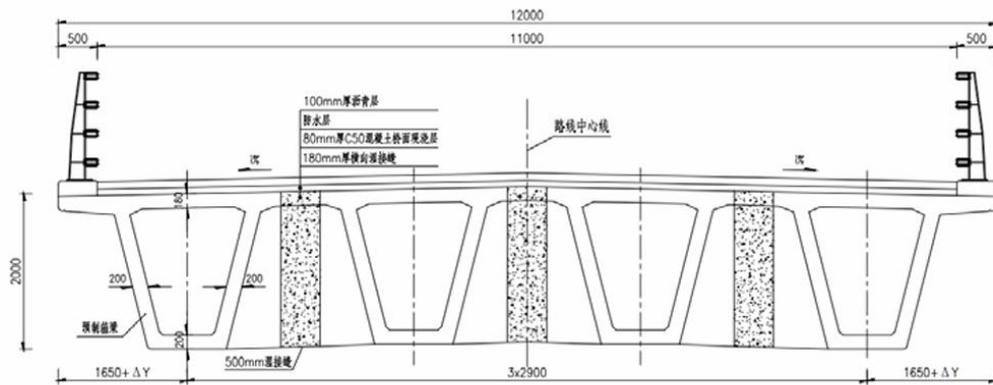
12m 宽桥梁标准横断面 (单位: mm)
